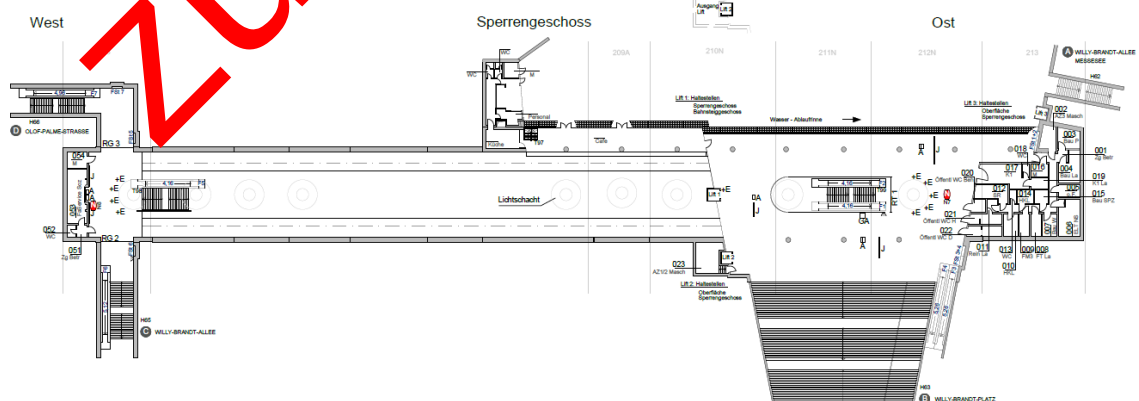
Grundriss Sperrengeschoss ME
